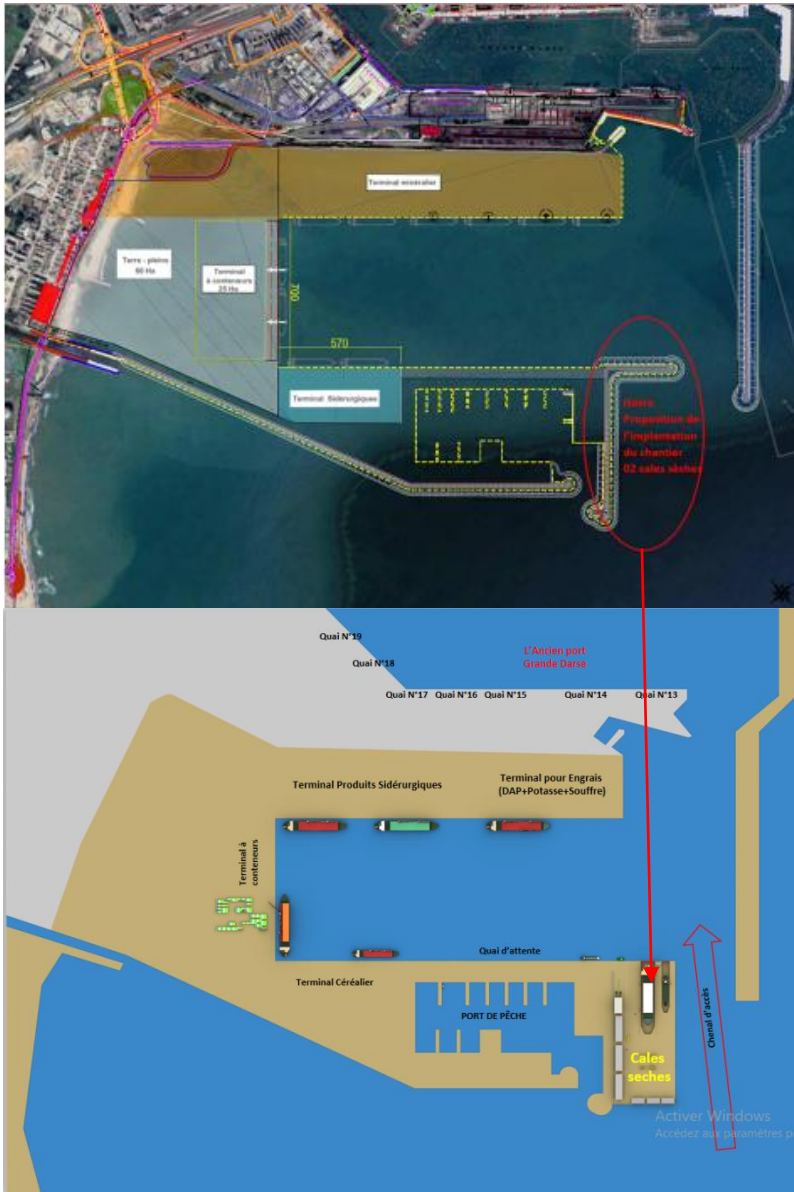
Plan N°01 : Vue sur le plan auto-cade sur Google-Earth, avec notre proposition d'implantation de chantier naval.
